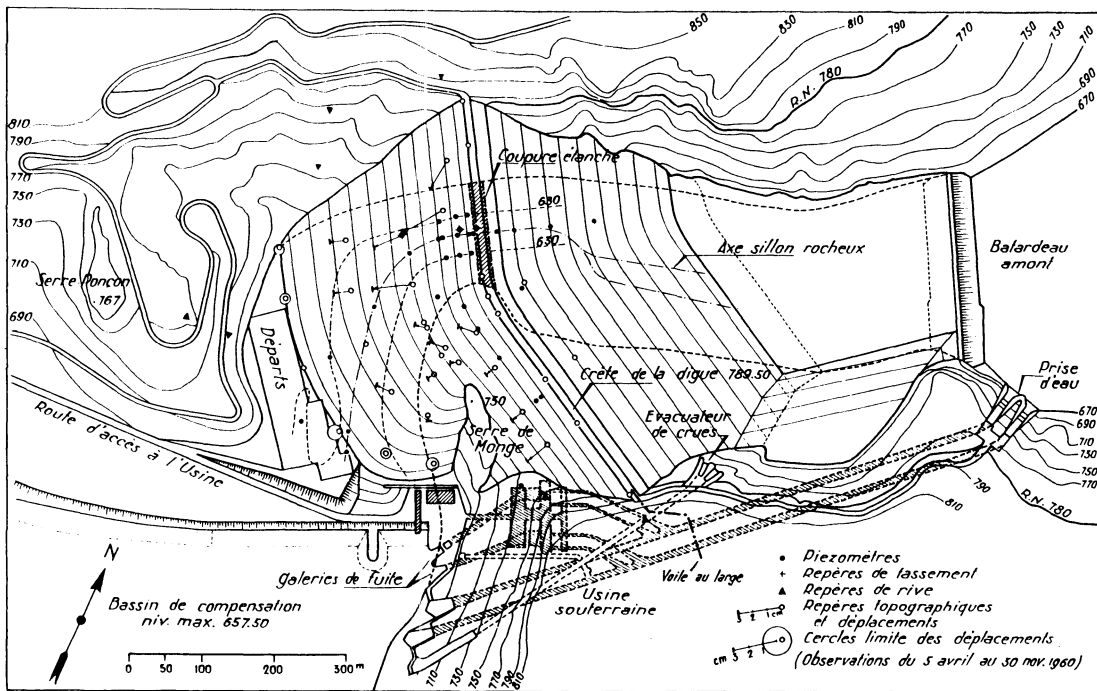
Plan d'ensemble des ouvrages et implantation du dispositif d'auscultation
